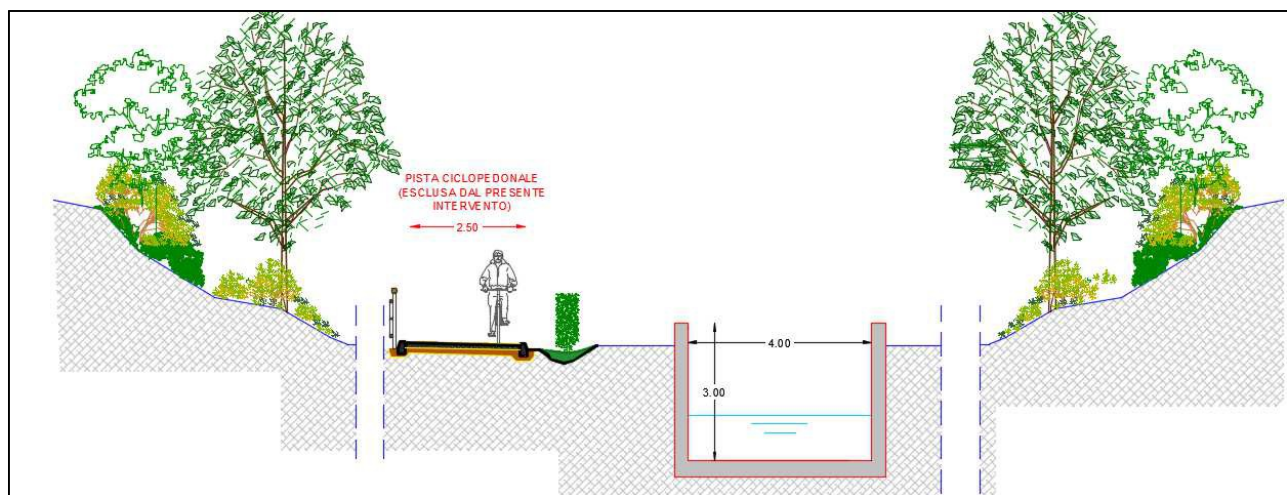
Canale a sezione rettangolare in c.a. aperto
